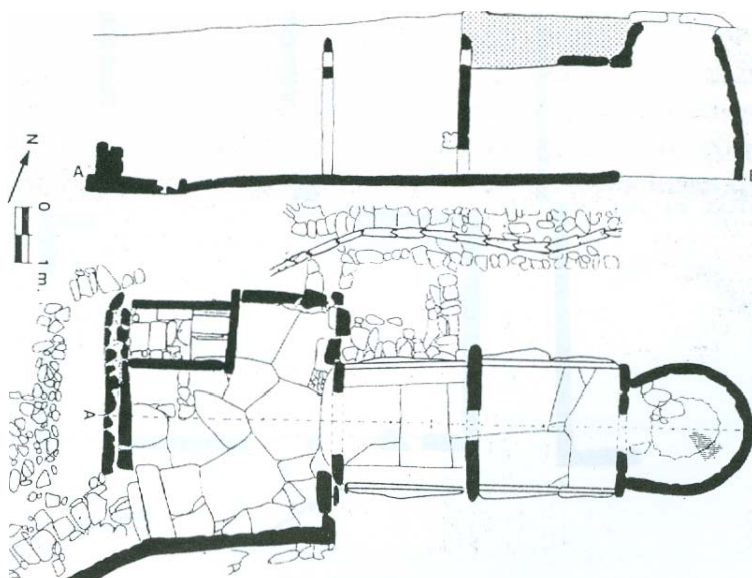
Planta y alzado de la «sauna» de Santa María de Galegos (Silva, 1986).
